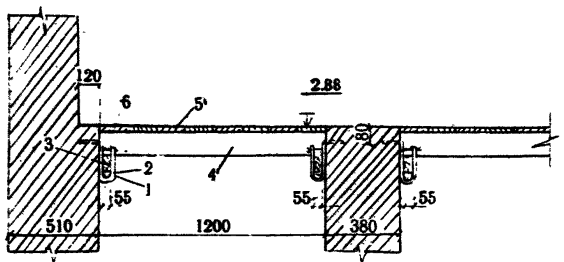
Опираие опалубки монолитных участков перекрытия на металлические крюки, заделанные в кирпичные стены: 1 - металлический крюк; 2 - клиновой вкладыш; 3 - деревянный прогон 50x150 мм; 4 - деревянная балка 50x150 мм; 5 - опалубочный настил из досок ($\delta = 25$ мм); 5 - проволоочная скрутка
